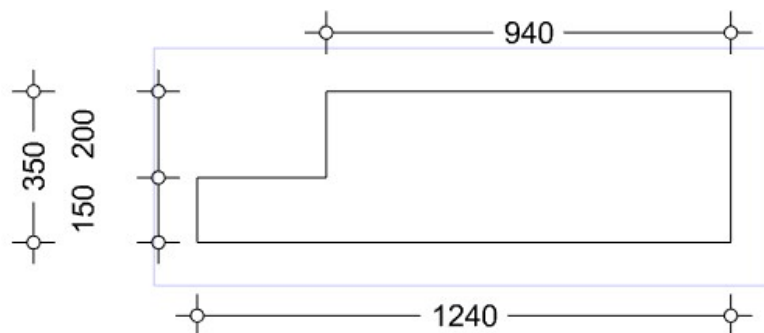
Tipikal Model *Redesign Half Slab* Tipe – 1A
